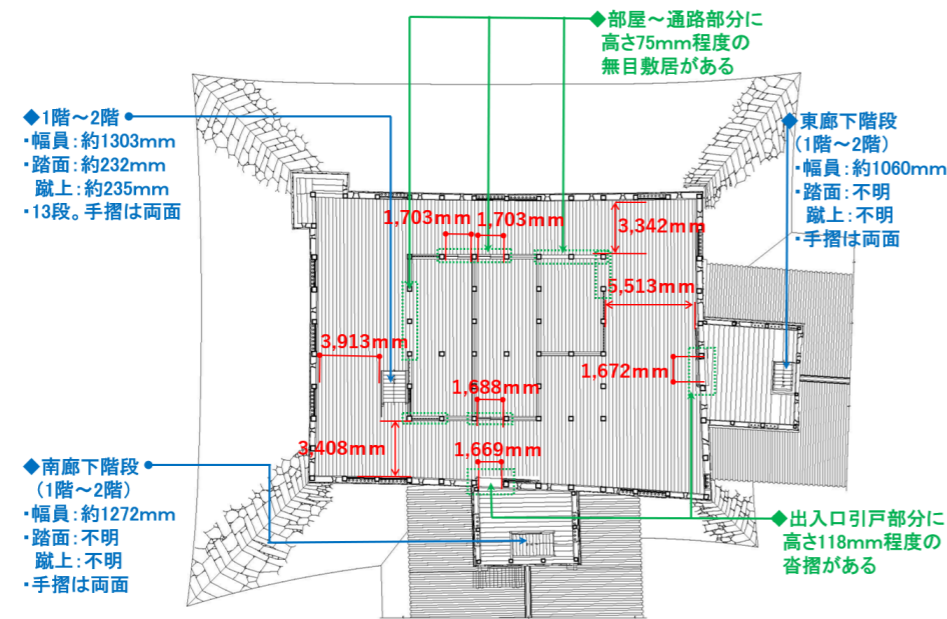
天守 1 階平面図及び東廊下・南廊下 2 階平面図（復元原案）
